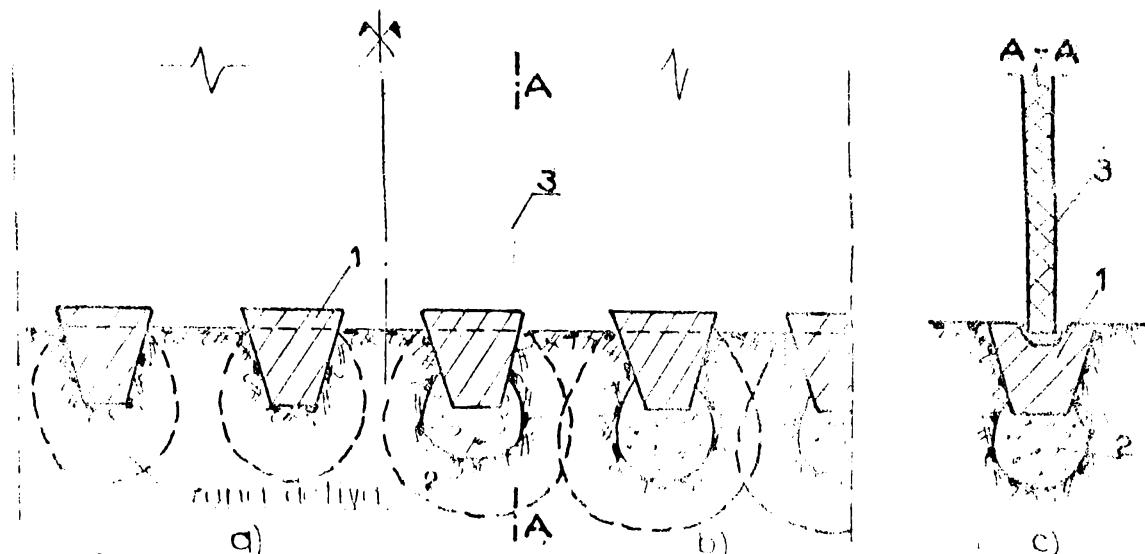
Fundații cu tâlpi discontinue: a) elemente discontinue fără bulb; b) elemente discontinue cu bulb; c) secțiune verticală prin fundație: 1) element prefabricat sau monolit; 2) bulb din material granular; 3) elevație prefabricată.
